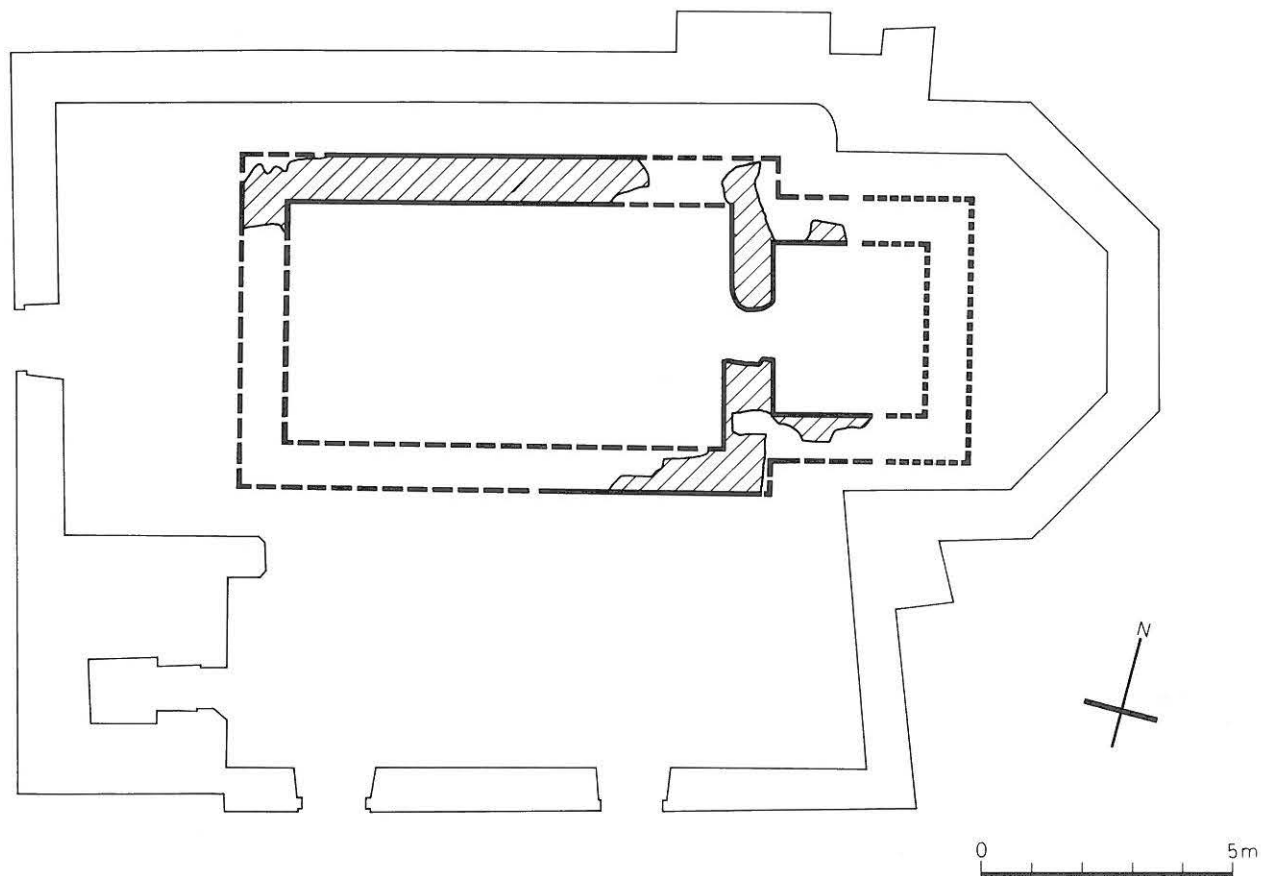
Rekonstruktion des Grundrisses der Kirche II (Fundament). M. 1:150.
